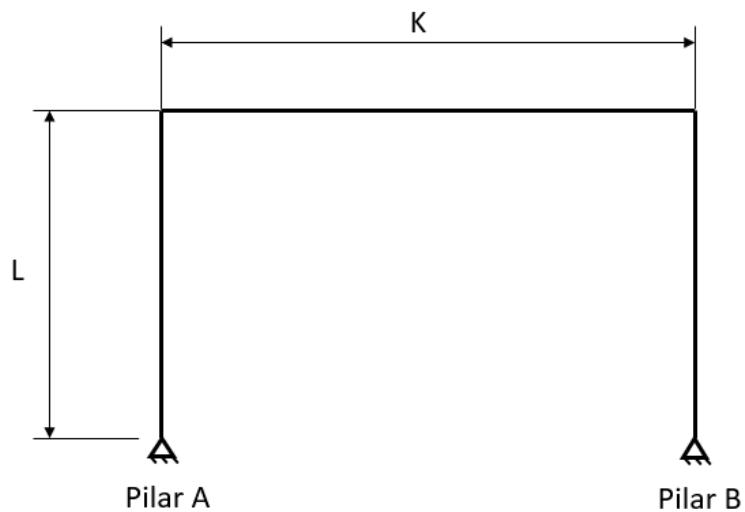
Pórtico biapoyado reticulado. Elaboración propia.
